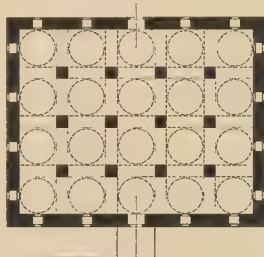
Sandal Besestan. Grundrisskizze.
